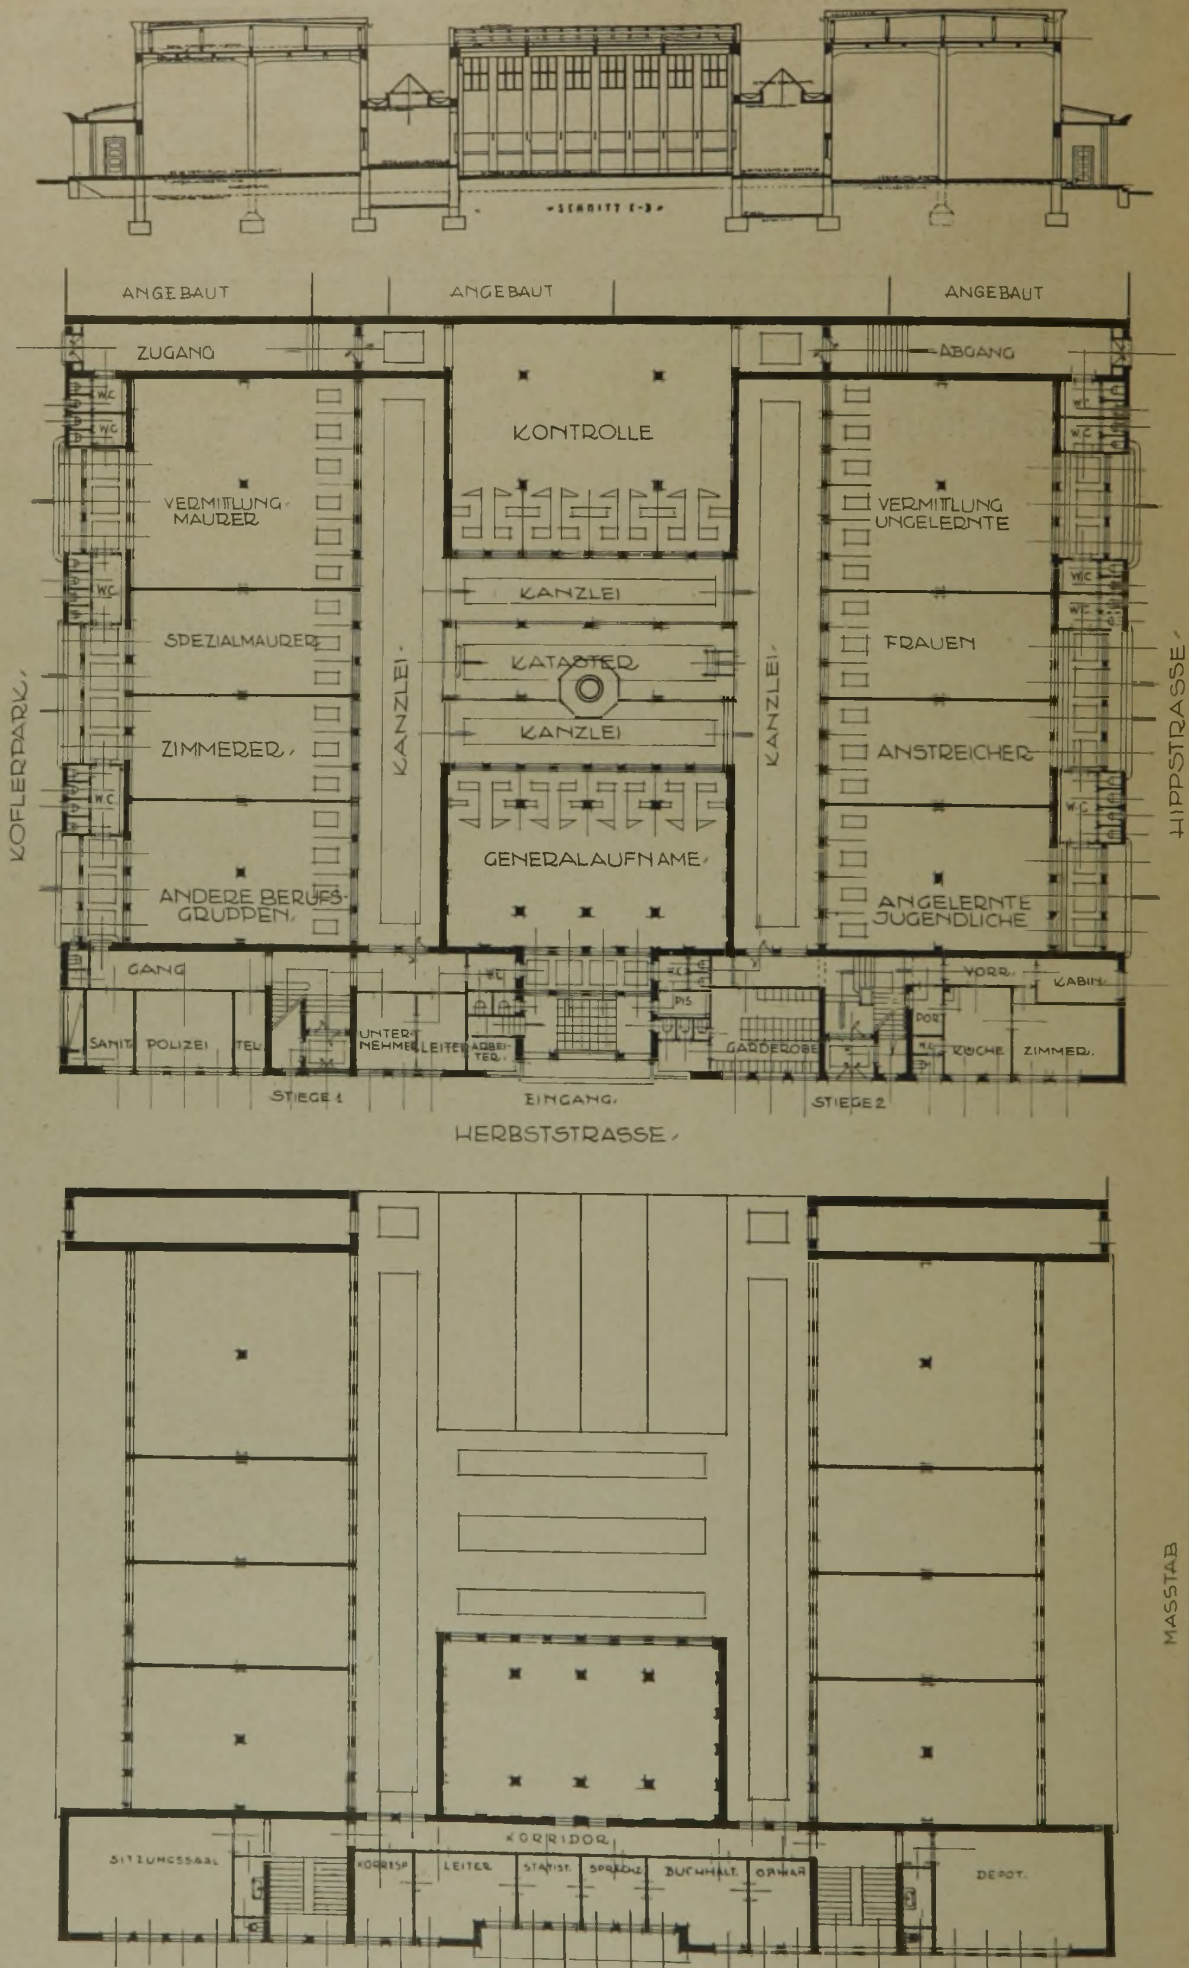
Schnitt (parallel zur Herbststraße), Erdgeschoss- und Obergeschossgrundriß. (Maßstab 1 : 400.)
